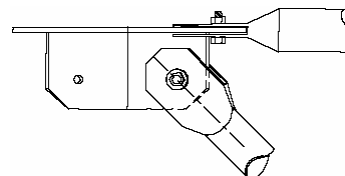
Ligação típica e nó de aplicação da carga (Silva, 1999)
